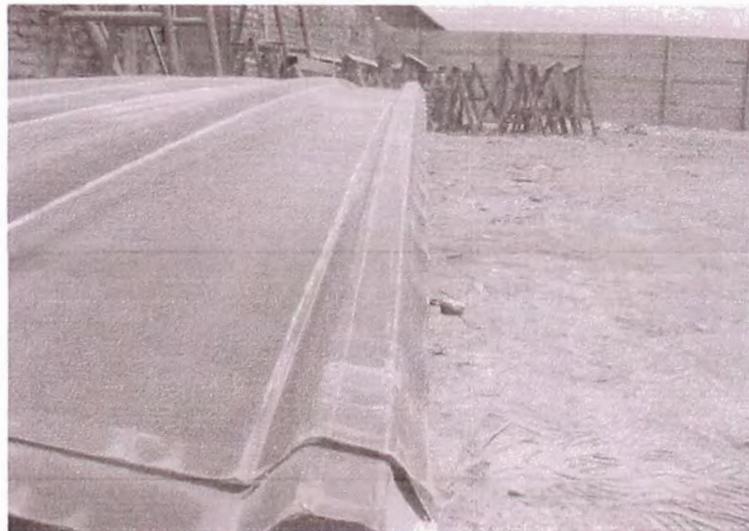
Conformado de plancha o coberturas en el lado de junta o traslape
